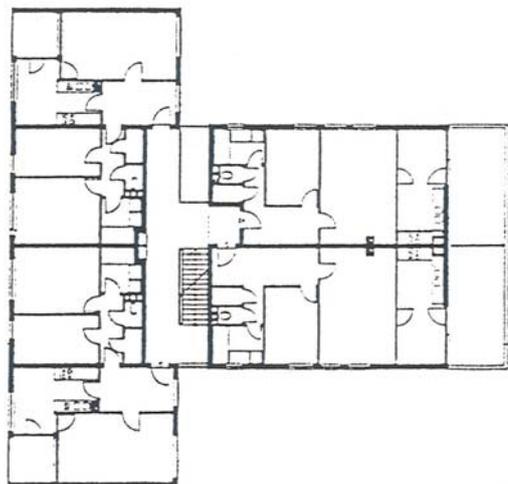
Grundrisse nach Entwürfen von Arch. Häuselmayer (l)
